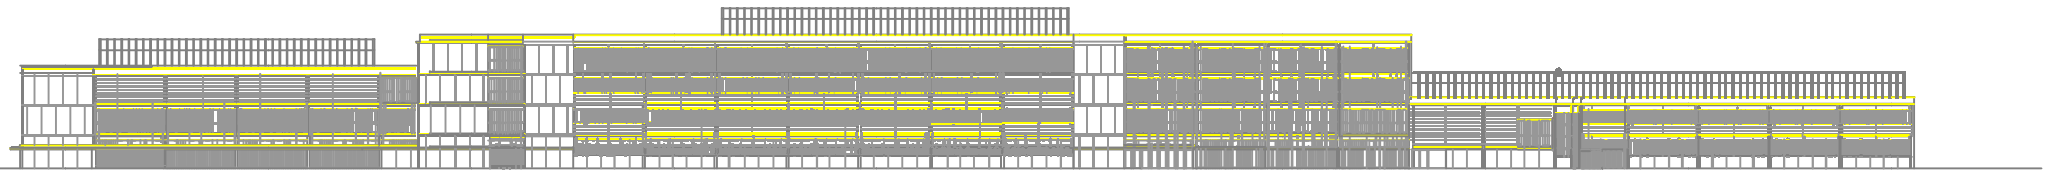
Fachada Sur del edificio M.A. Betancourt
